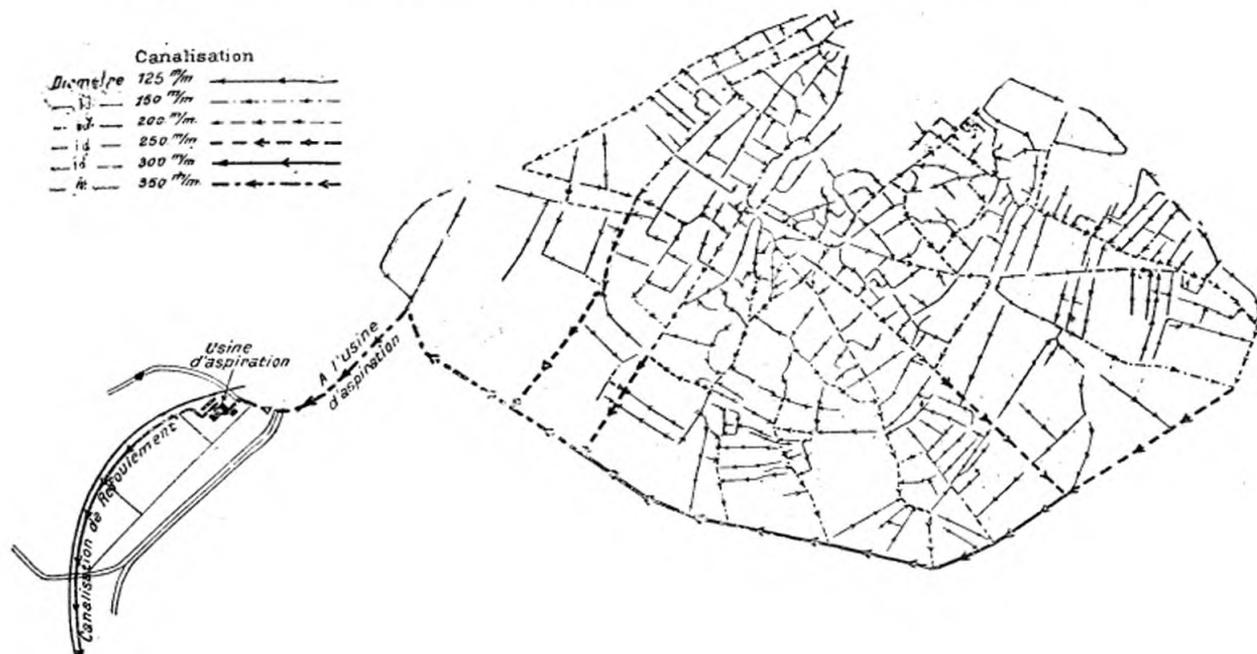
Projet d'assainissement d'Avignon par le système de Levallois-Perret. (Plan général de la canalisation).
